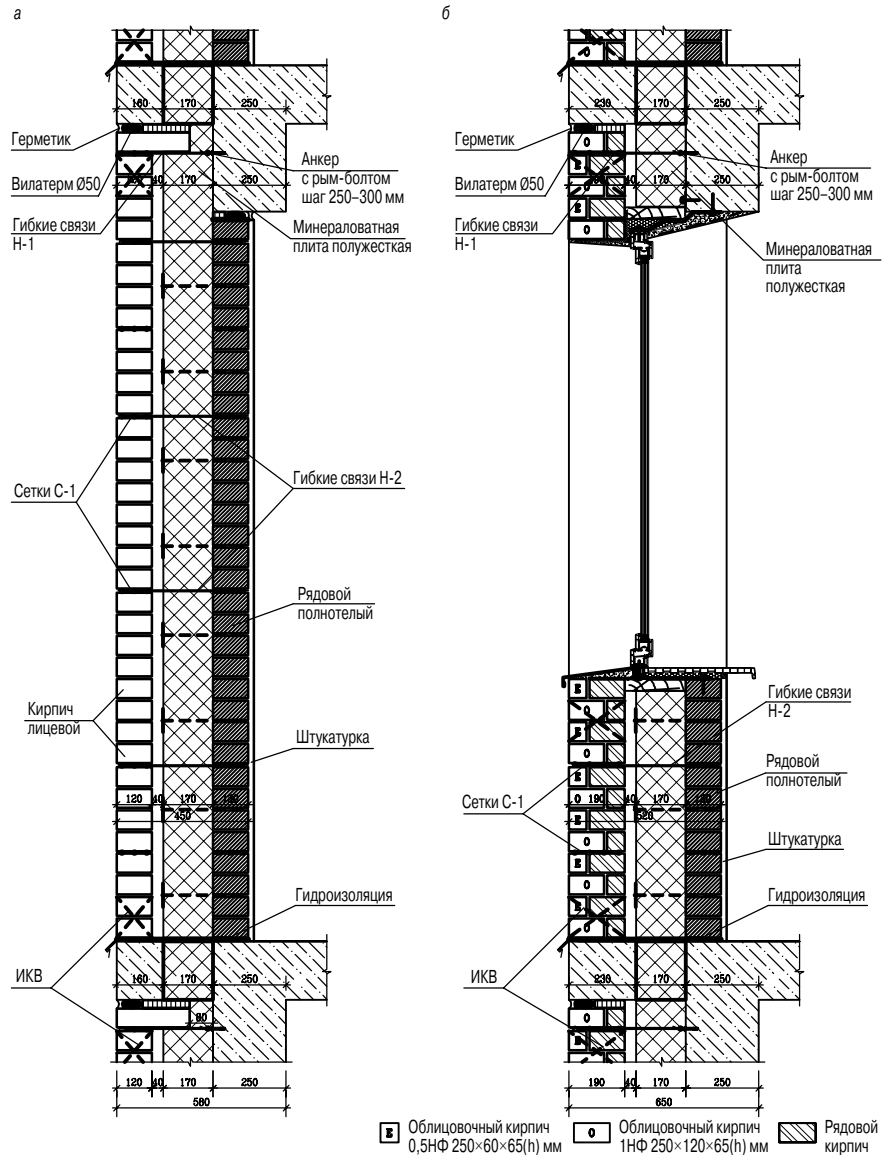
Наружная стена тип 2 с внутренним слоем из кирпичной кладки, наружный слой толщиной: а – 120 мм; б – 190 мм
